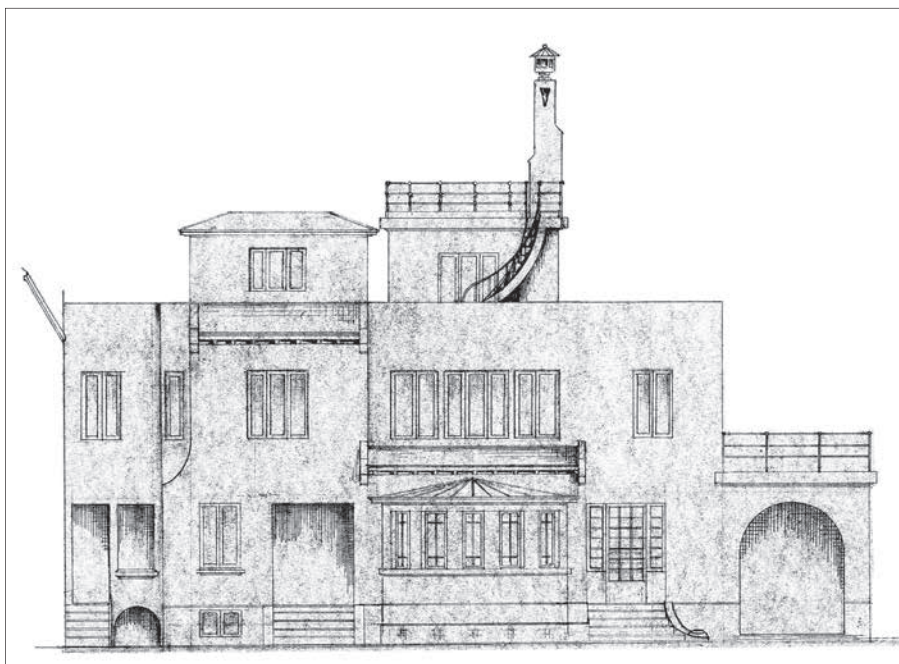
Dibujo plano original de la vivienda. Fuente: Archivo digital de plano facilitado por el Sr. Felipe Silva, arquitecto asesor de Secpla Ñuñoa.
